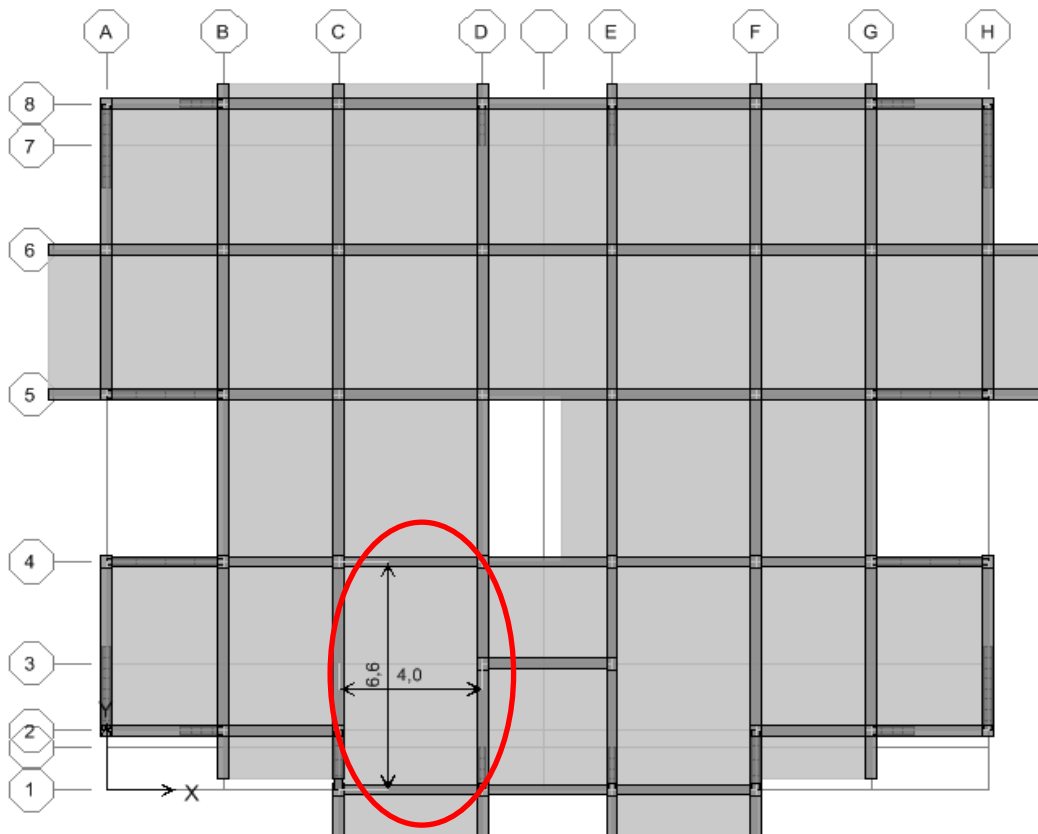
Panneaux de dalle du radier (e = 45cm)
